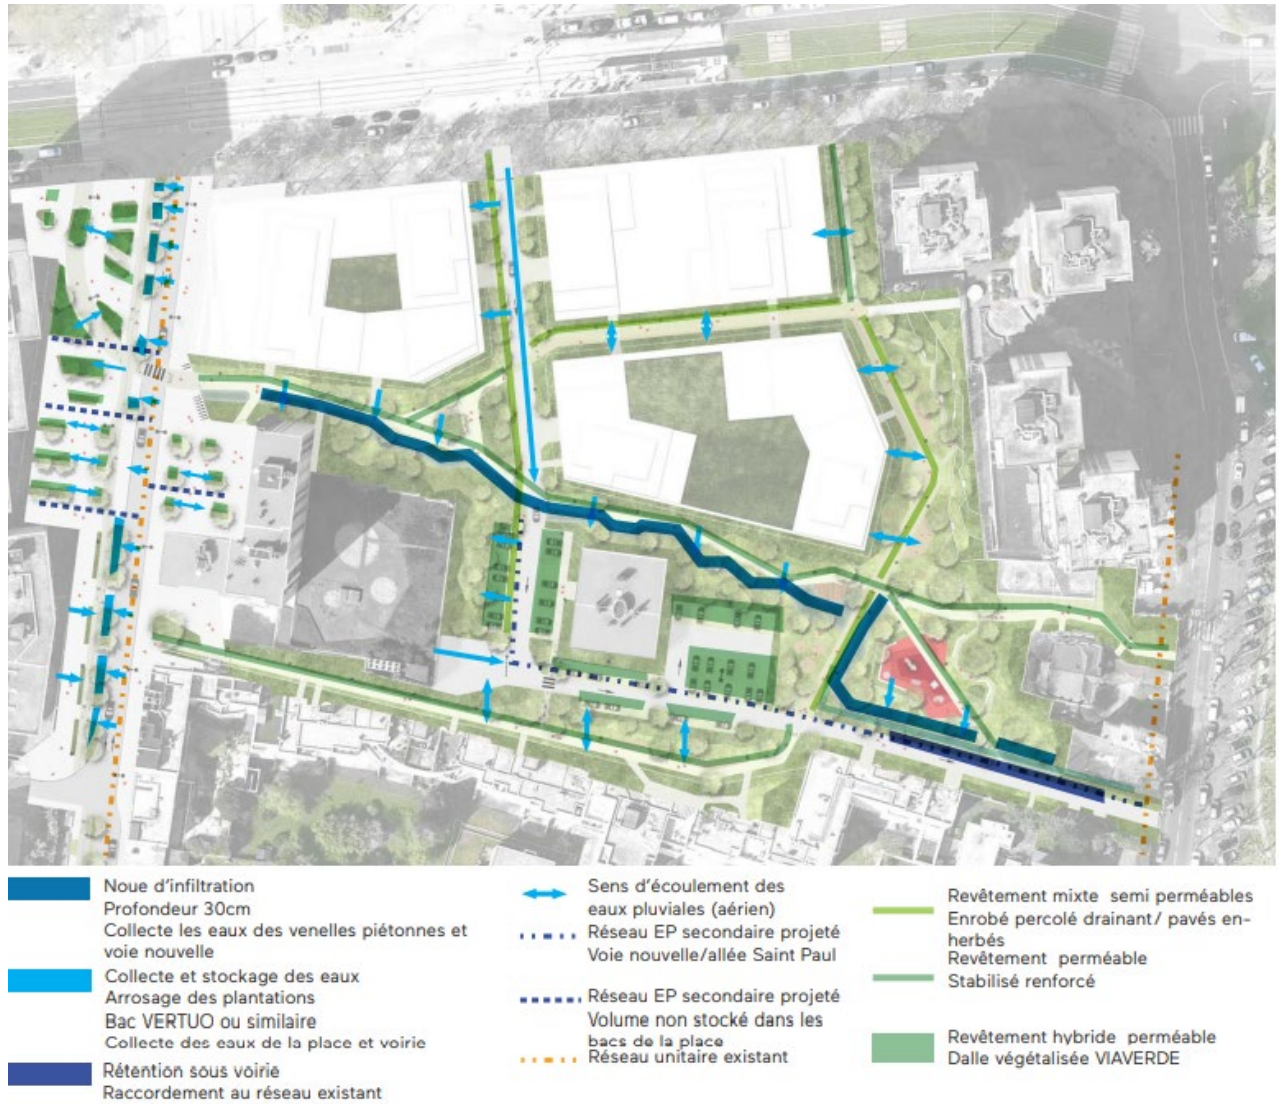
Schéma de la gestion des eaux pluviales (Endroits en vert – 2023)
